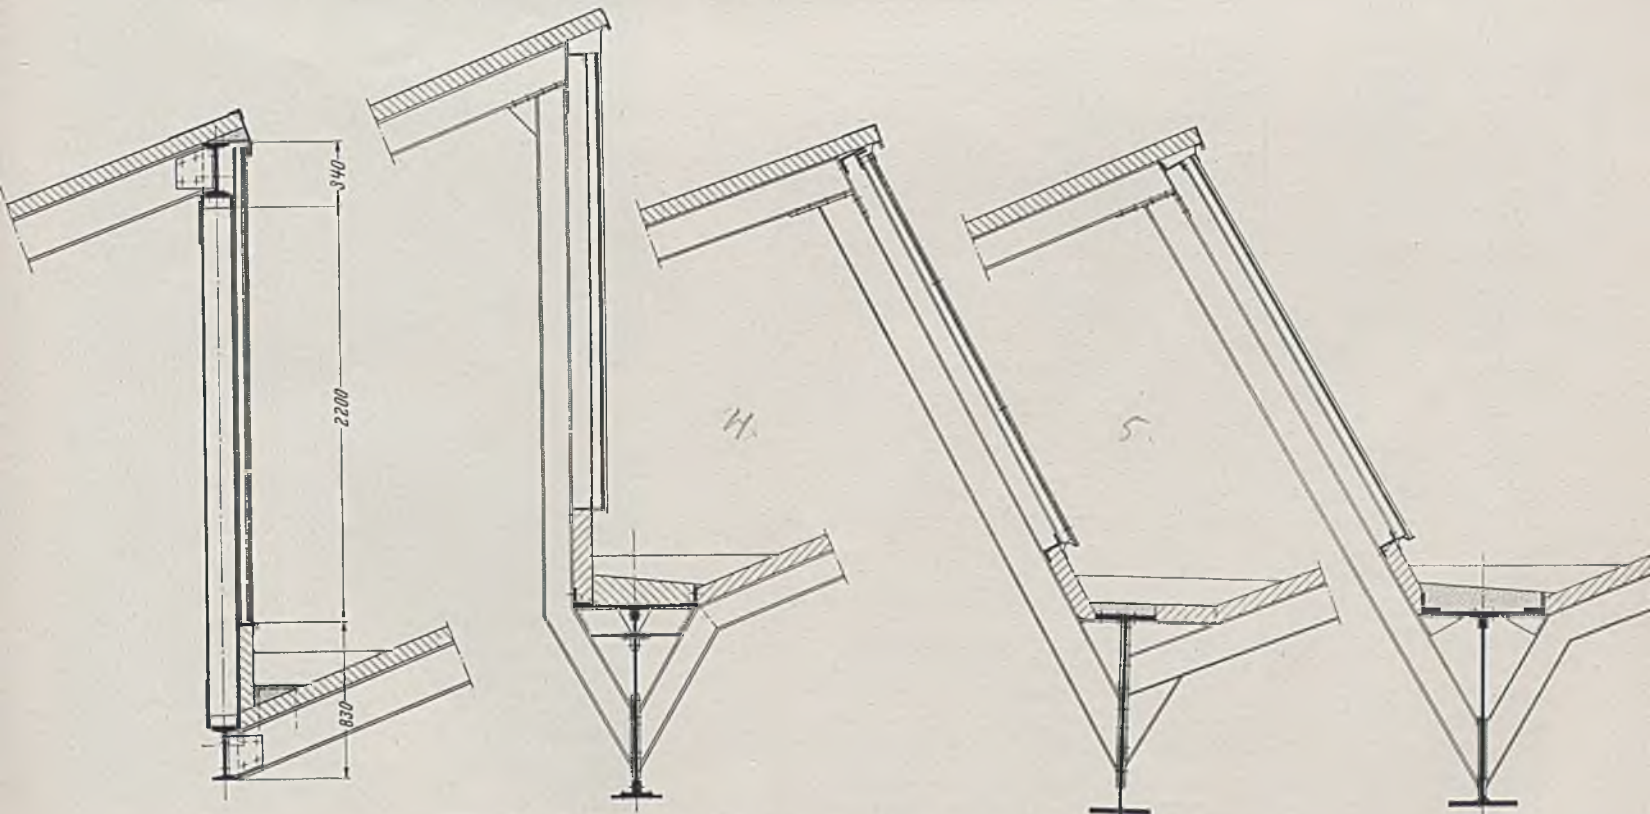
a—d. Bau 6 und Bau 7: Studien für die Ausführung des Sägedaches.
